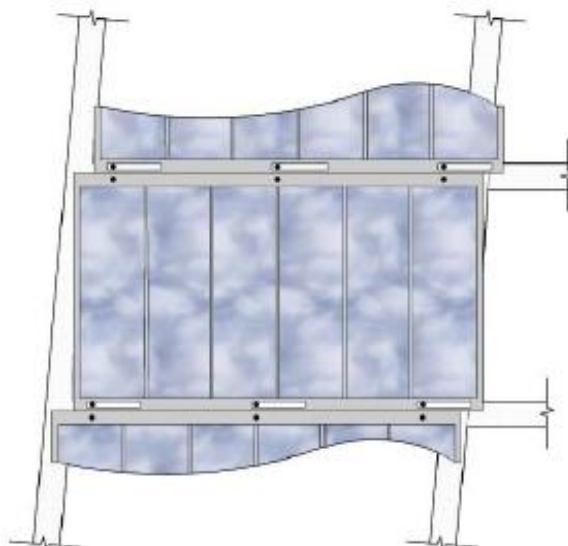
Modelo utilizando sistema de fachadas cortinas com isolamento sísmico. Adaptado de[31]
